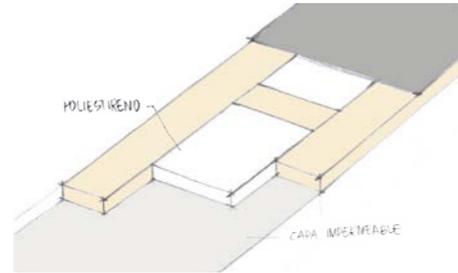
Detalle zuncho perimetral de cimentación previo a la colocación de los paneles.
